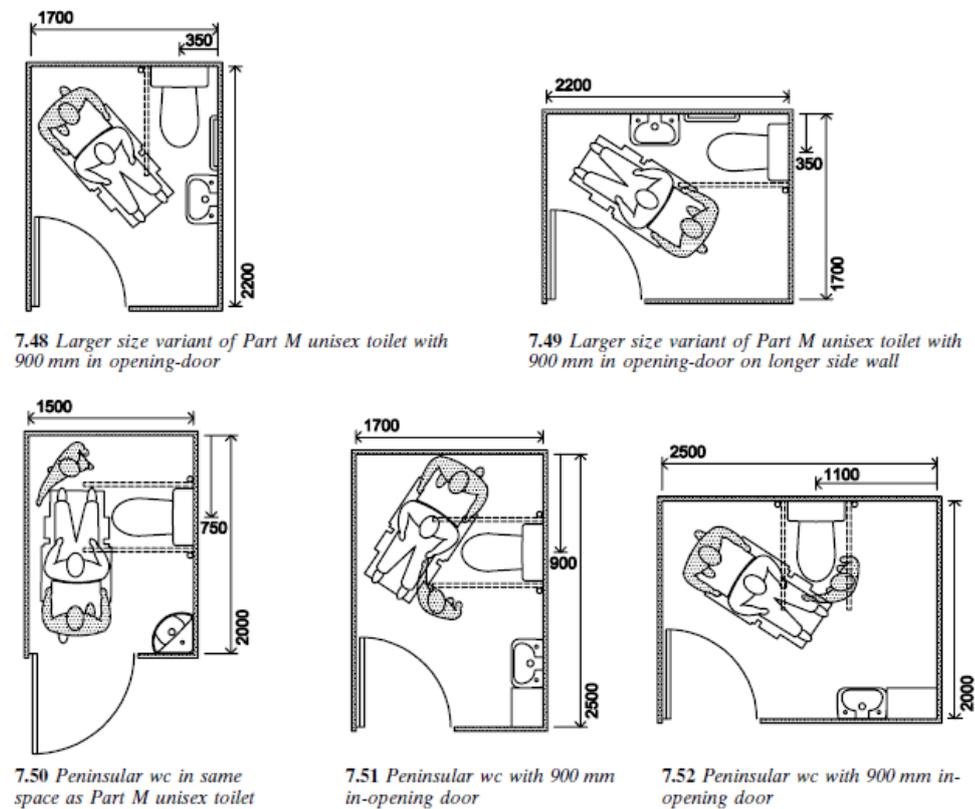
94 Contoh Ukuran Ruang Gerak Dalam Toilet
